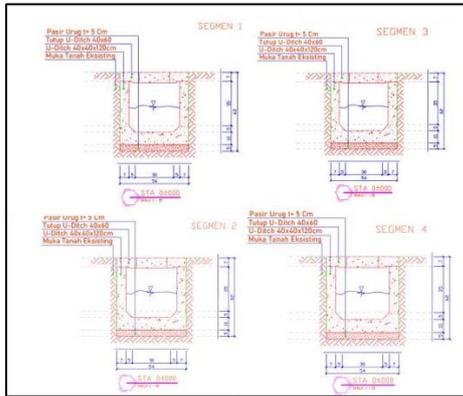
DED Siteplan Segmen Drainase di Kelurahan Margaluyu
